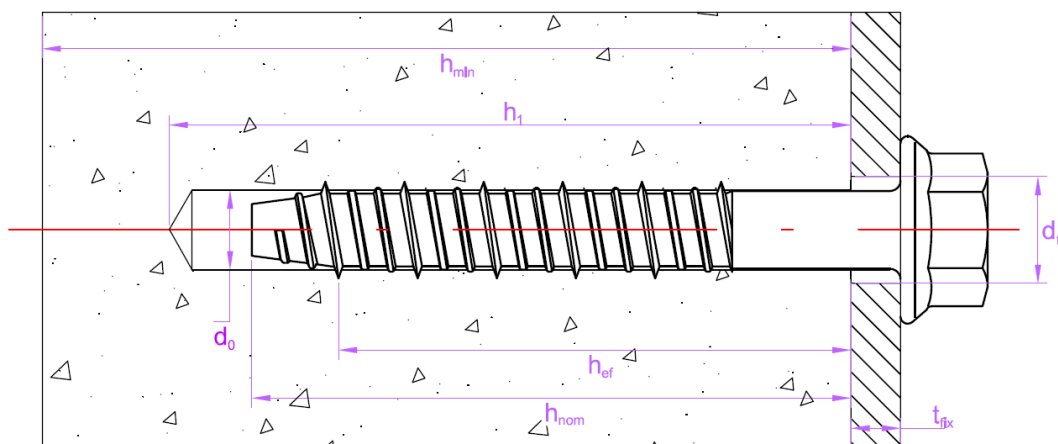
Esquema de instalación para anclajes SSW, SSR, SSP, SSK, SSH, SSX, SST y SSN.
